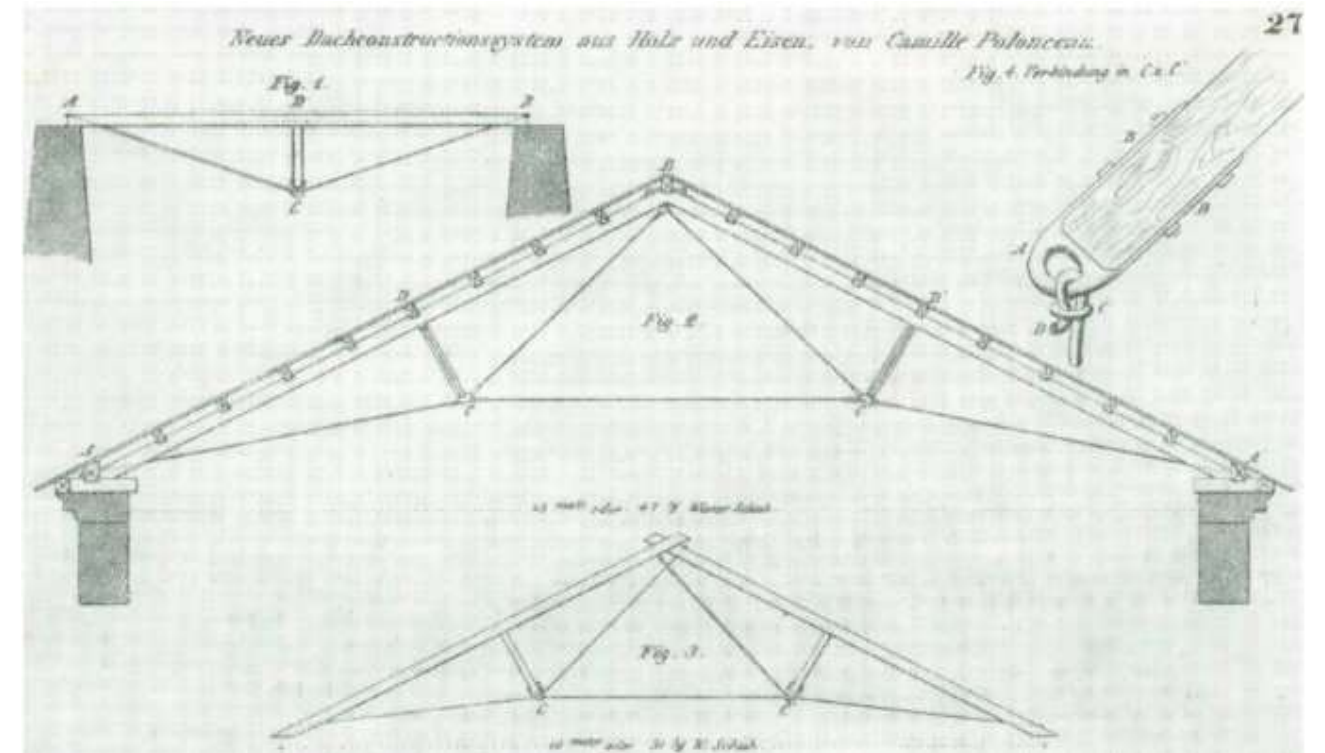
Dachkonstruktionssystem von Camille Polonceau
